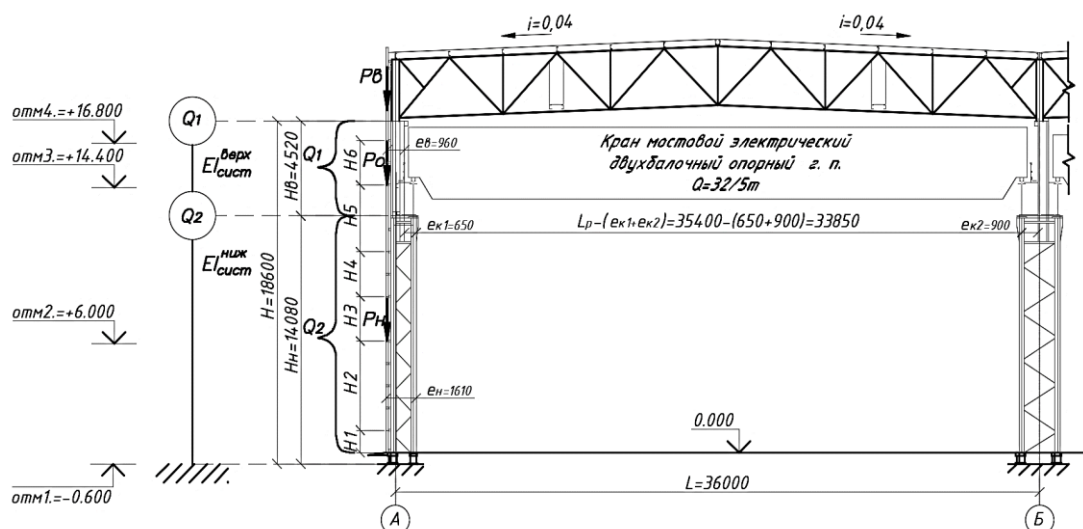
Формирование динамической расчетной схемы для производственного здания с мостовыми кранами при шарнирном сопряжении стропильной конструкции с колоннами
